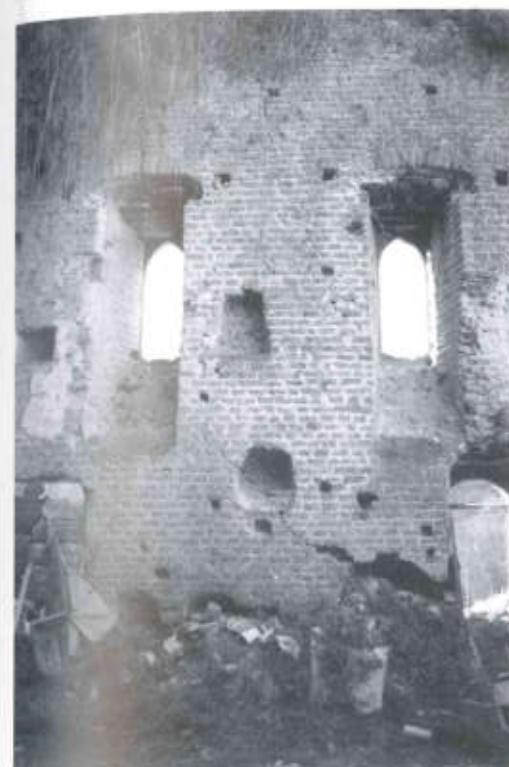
/ Particolare delle aperture ad ogiva sul prospetto Sud, dall'interno.
